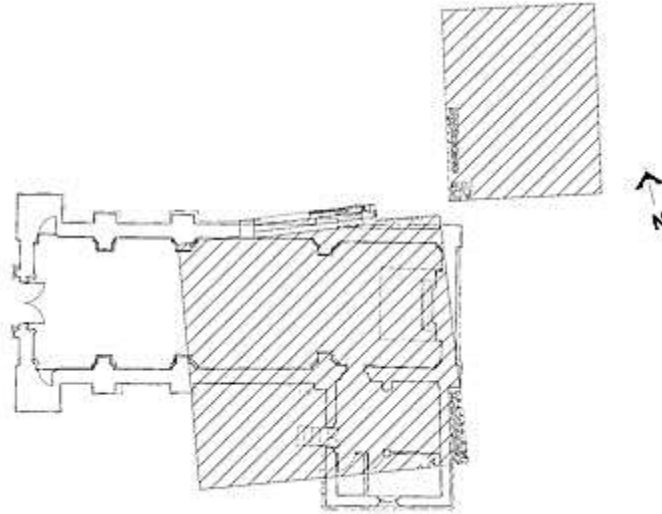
Proyección de las estructuras arquitectónicas del Epiclásico.
